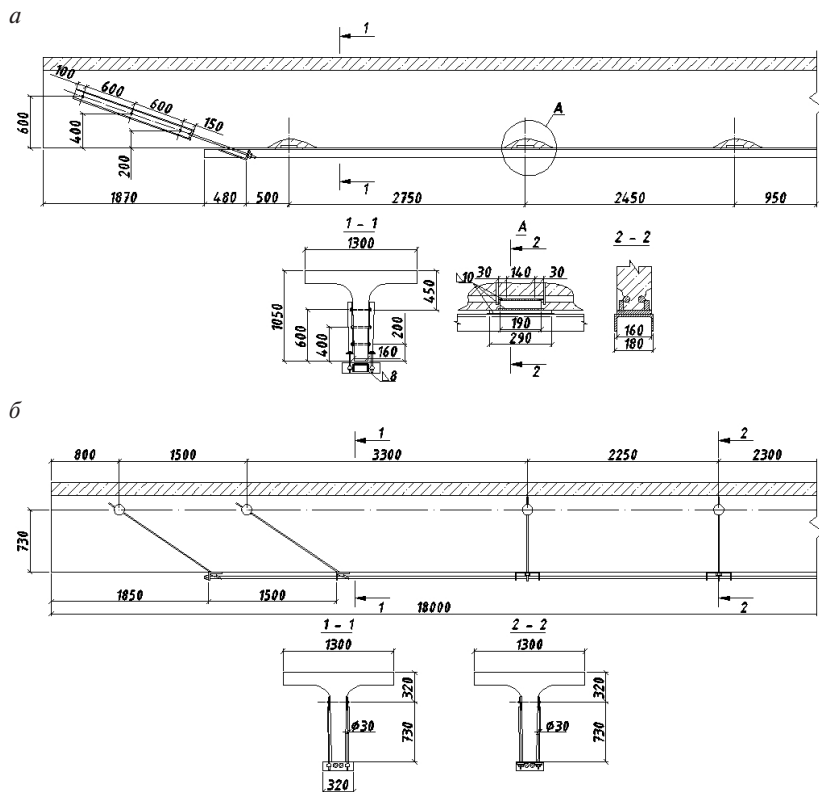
Конструкция усиления главных балок пролетных строений металлом: *a* — приварка швеллера; *б* — постановка дополнительных стержней рабочей арматуры
